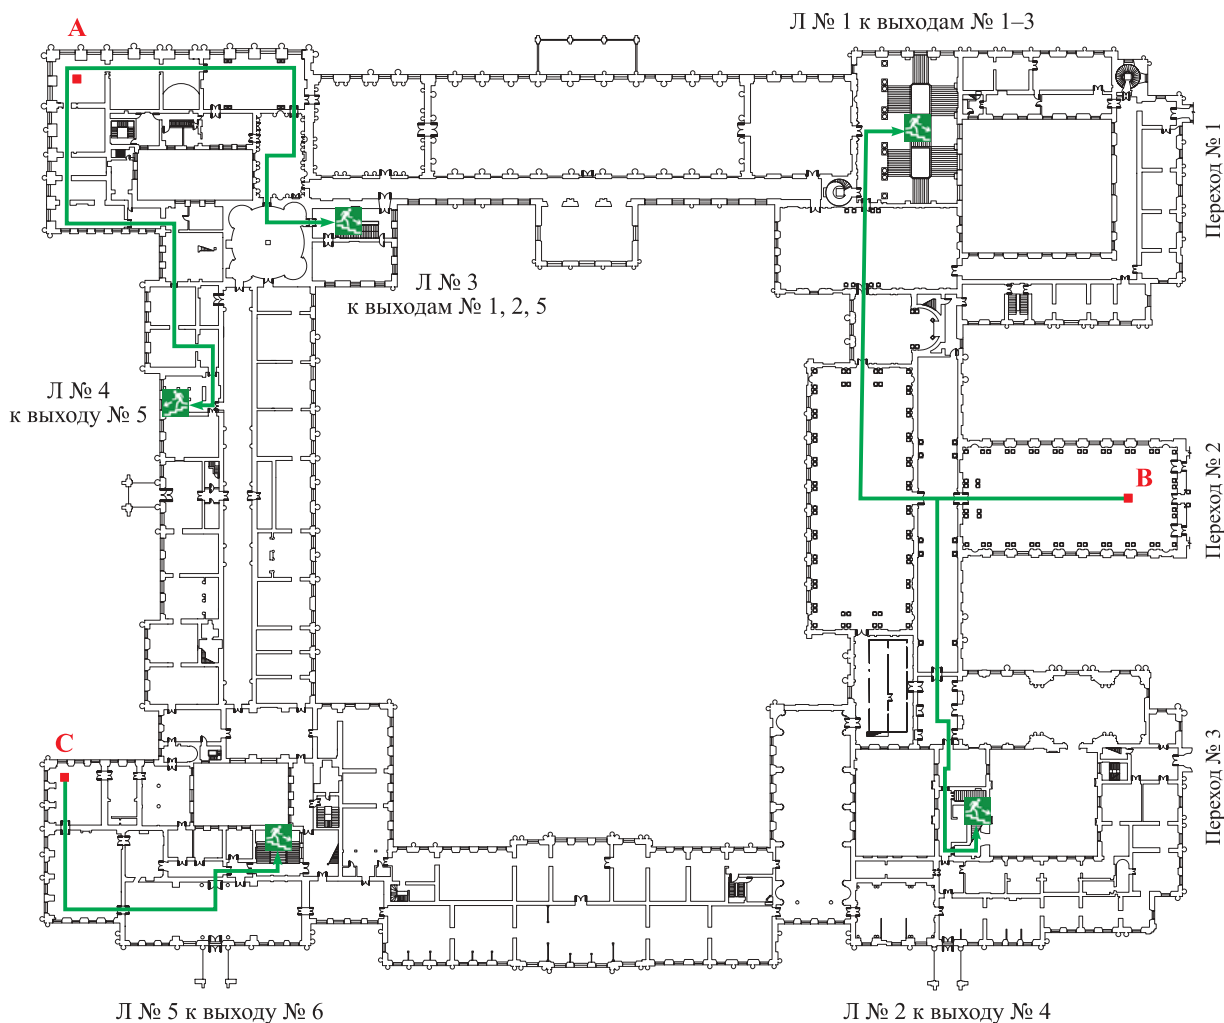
План 2-го этажа Зимнего дворца Государственного Эрмитажа
